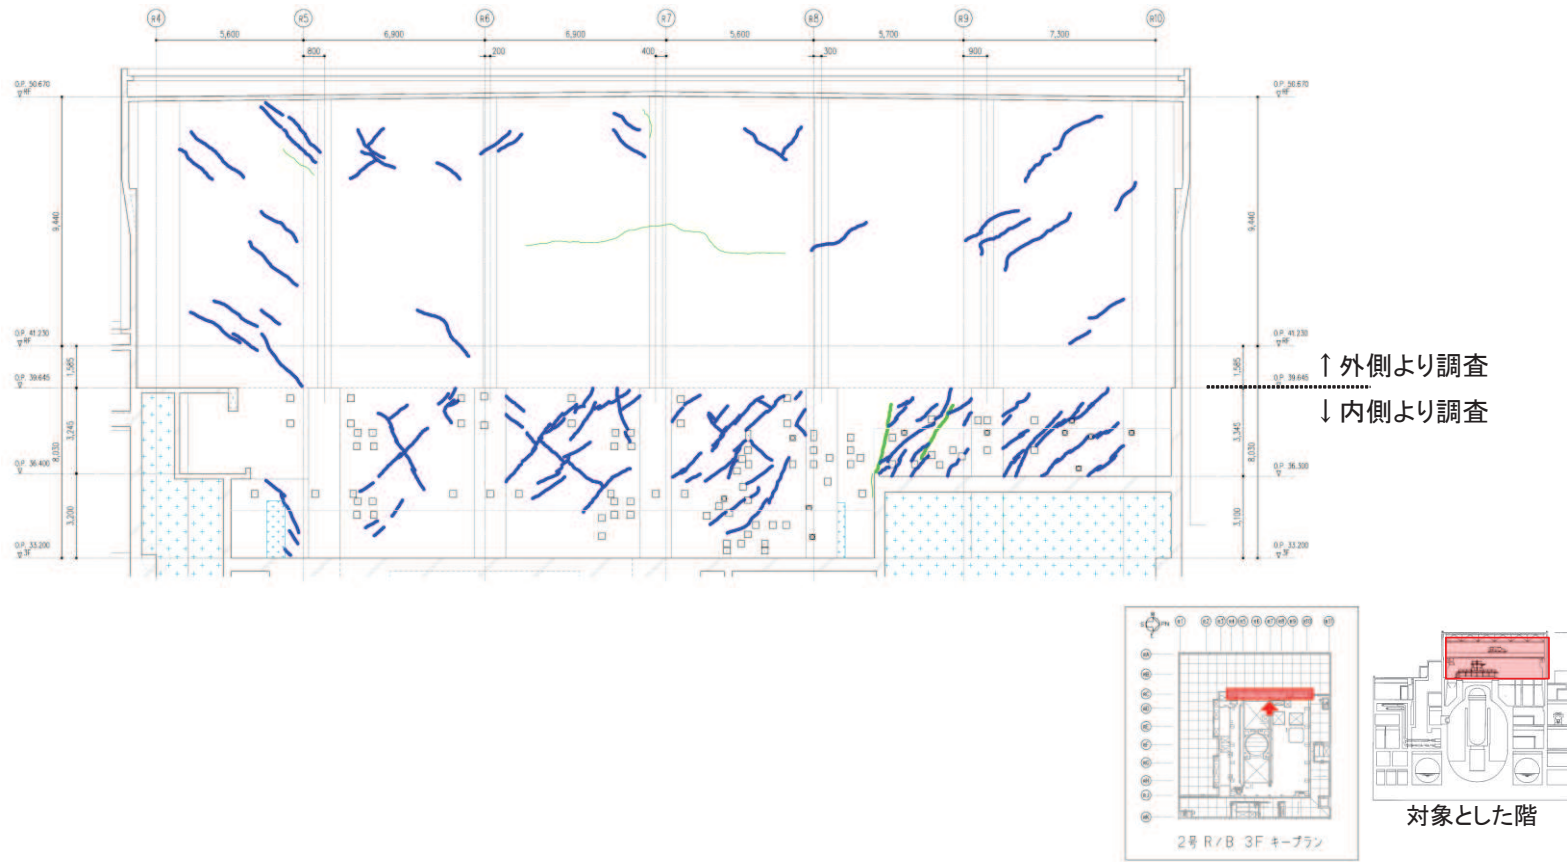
原子炉建屋のひび割れ分布 耐震壁 (49) 地上 3 階 R4 通り
